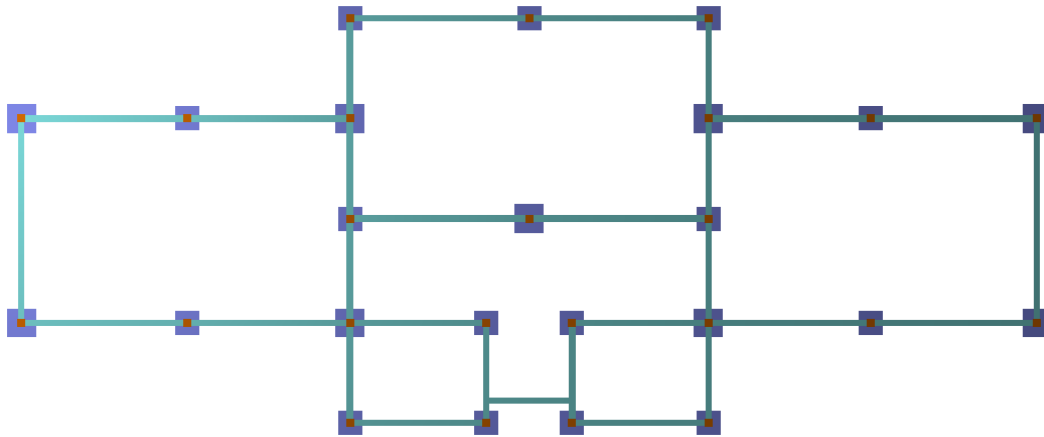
Distribución de zapatas en Bloque Laboratorios
